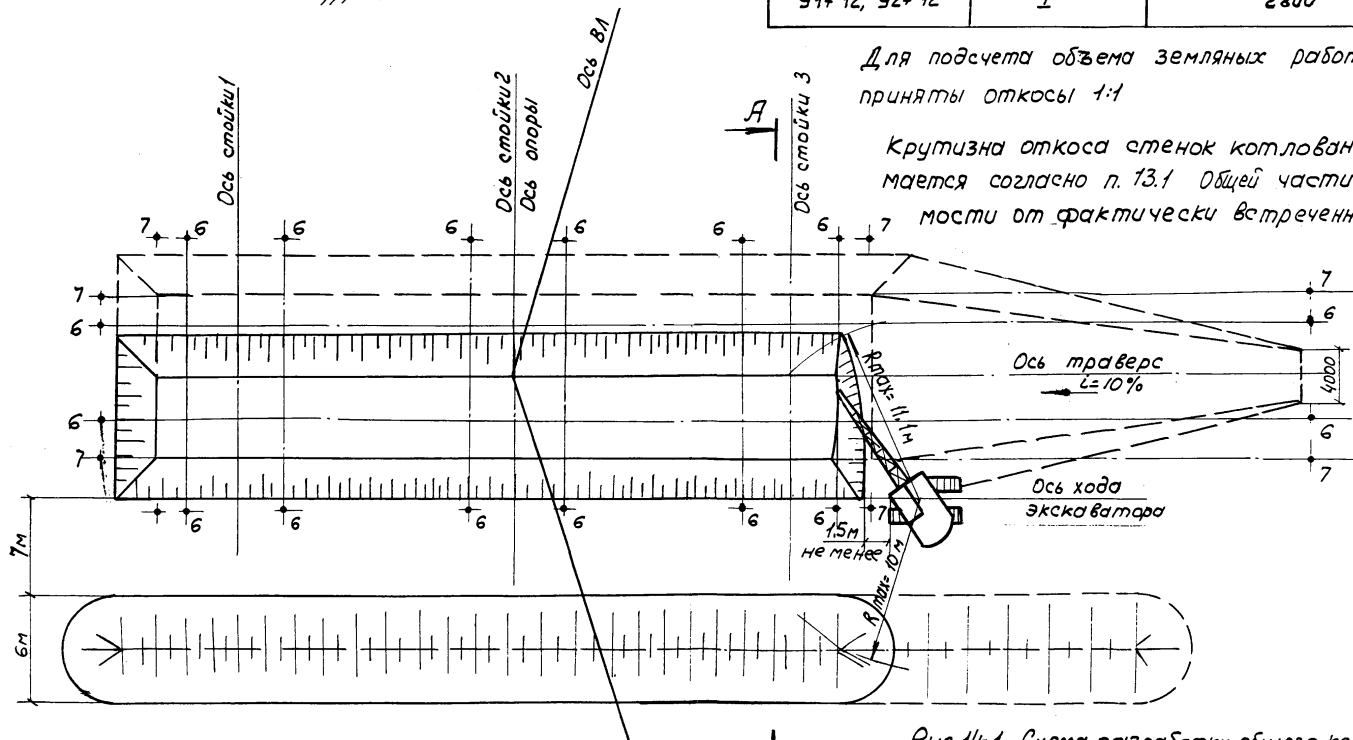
Схема разработки общего котлована под фундамент анкерно-угловых опор У1, У2, У1+3, У2+5, У1+12, У2+12 в песчаных и супесчаных грунтах
